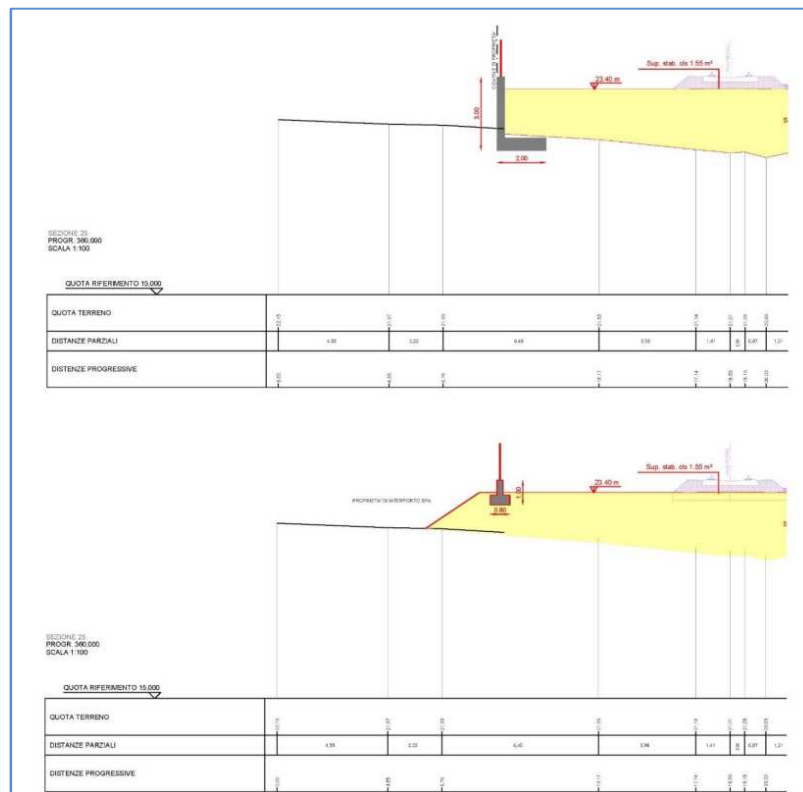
stralcio sezione tipo del muro di contenimento del piazzale per il nuovo fascio binari (intervento 2); sotto, stralcio sezione tipo del progetto modificato
